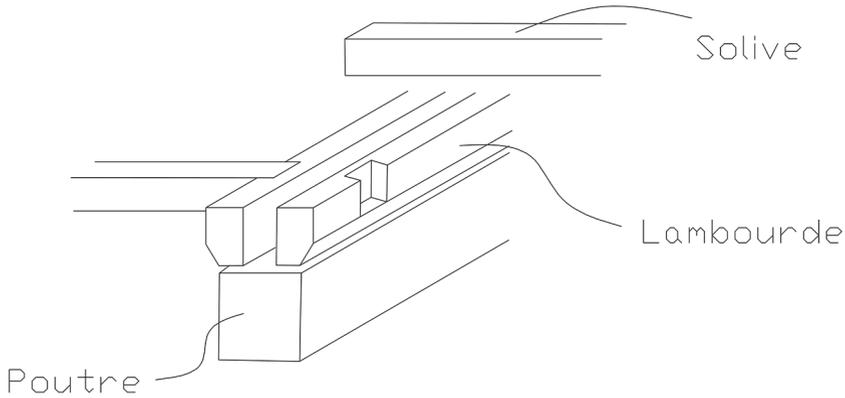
| Dispositions schématiques d'assemblage poutre/lambourdes/solives, dessin de l'auteur.
